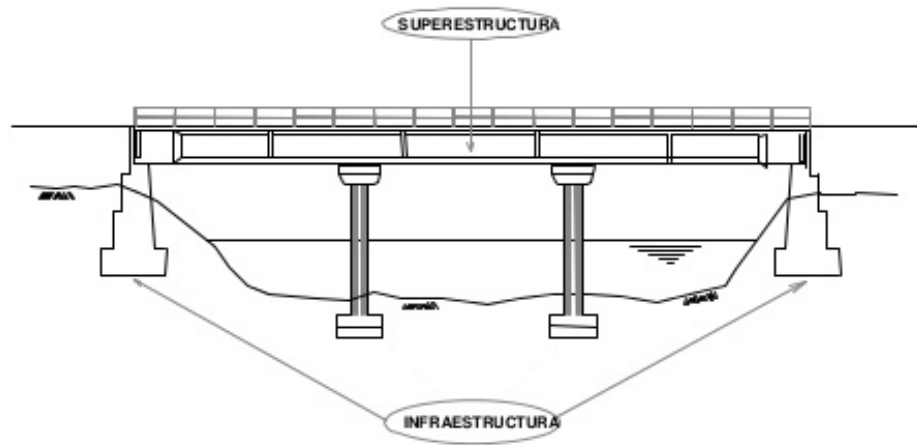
Puente de viga simplemente apoyado de un tramo
